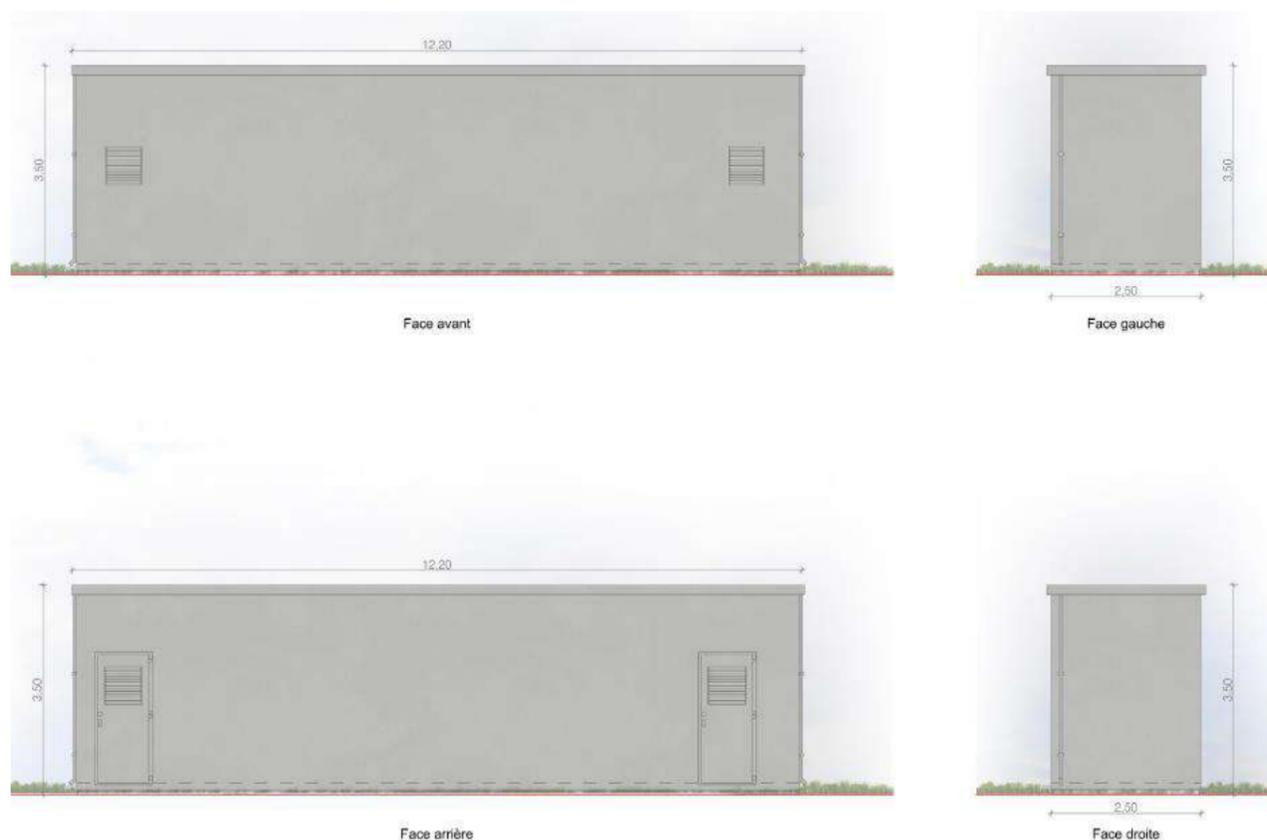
Plan des façades d'un poste de transformation (Source : dossier de PC)
